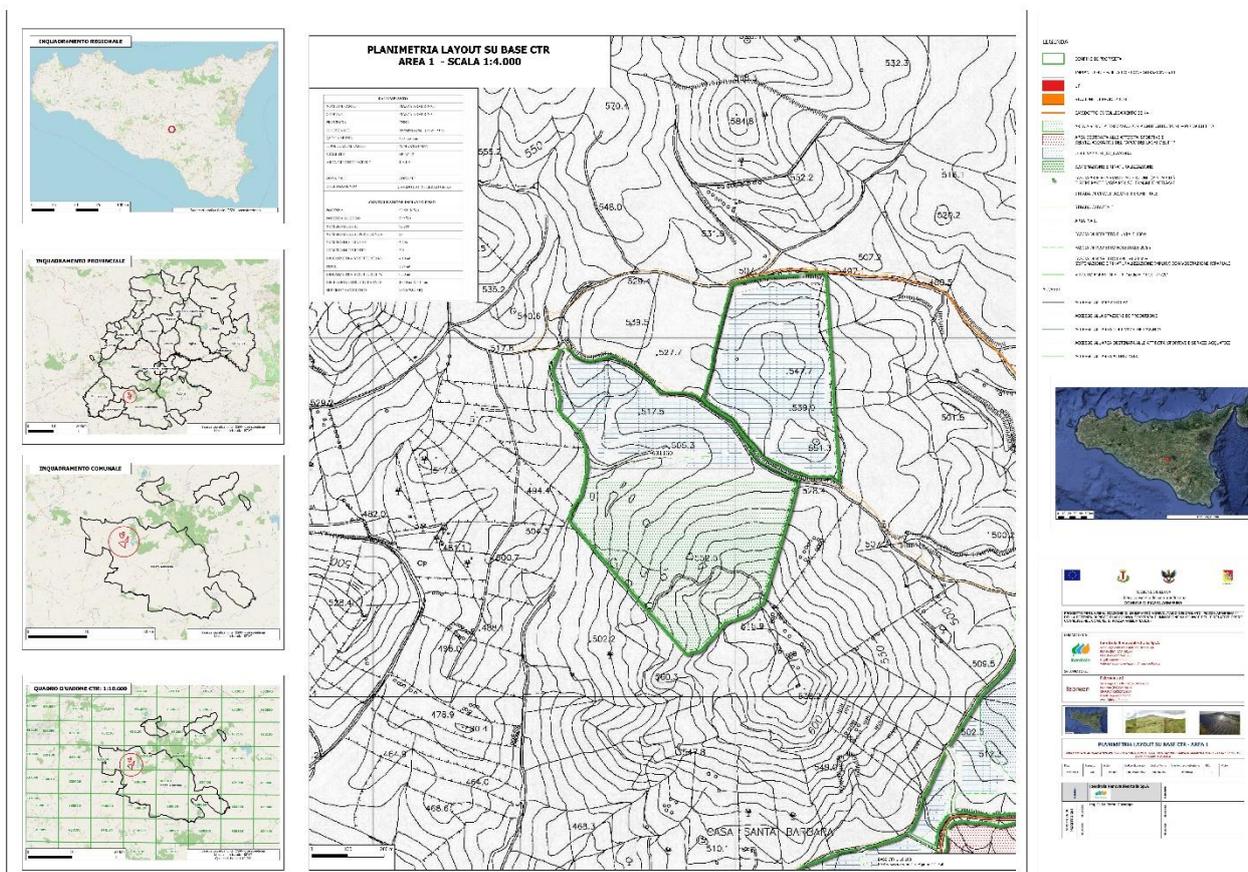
Planimetria layout – Area 1: Parco fotovoltaico area di intervento.
